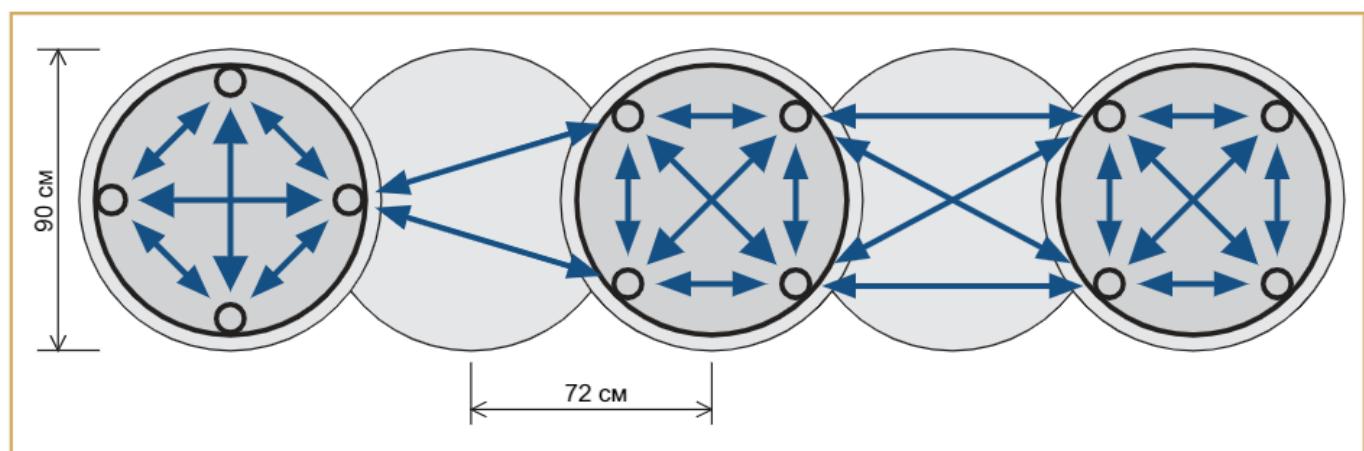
Схема наблюдений для межскважинного просвечивания ограждающей конструкции из буросекущих свай. Окружностями показаны поперечные сечения свай, кружками — наблюдательные трубы в сваях, жирными стрелками — направления ультразвукового просвечивания между трубками
